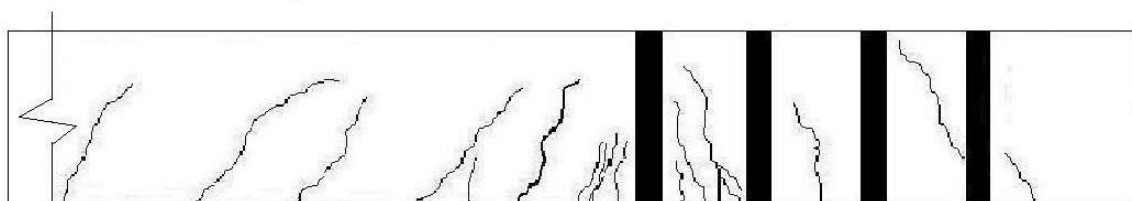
Panorama de fissuração da Viga V22.
